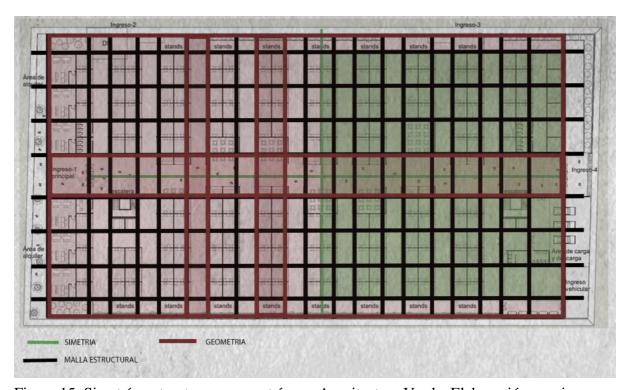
Simetría, estructura y geometría por Arquitectura Verde. Elaboración propia
